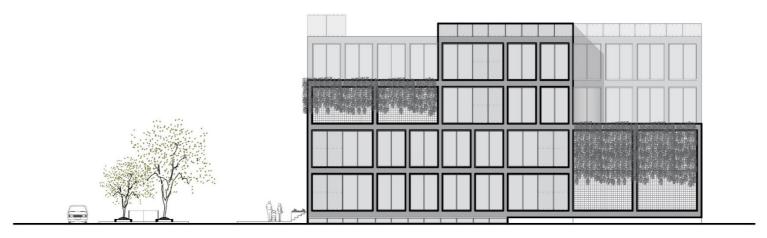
Fachada lateral derecha Fuente: elaboración propia
